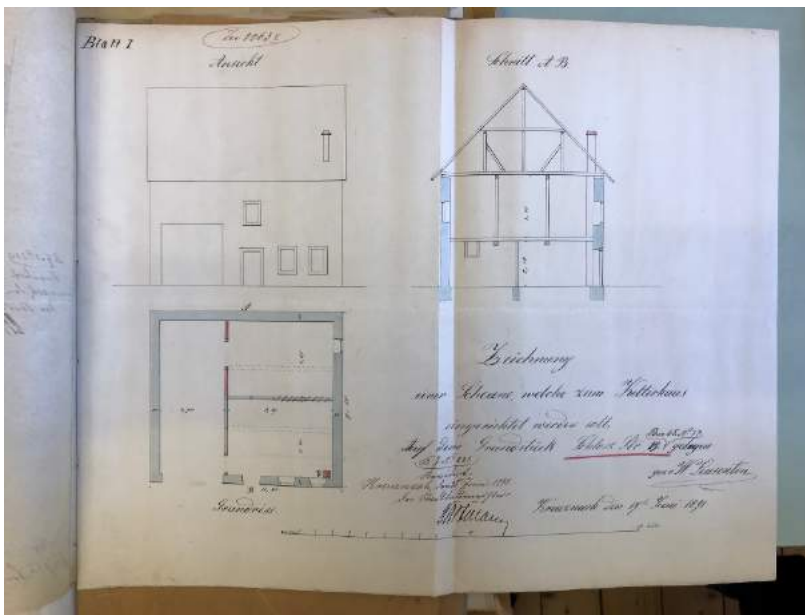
Schlosstraße 19 Bauplan Scheune
